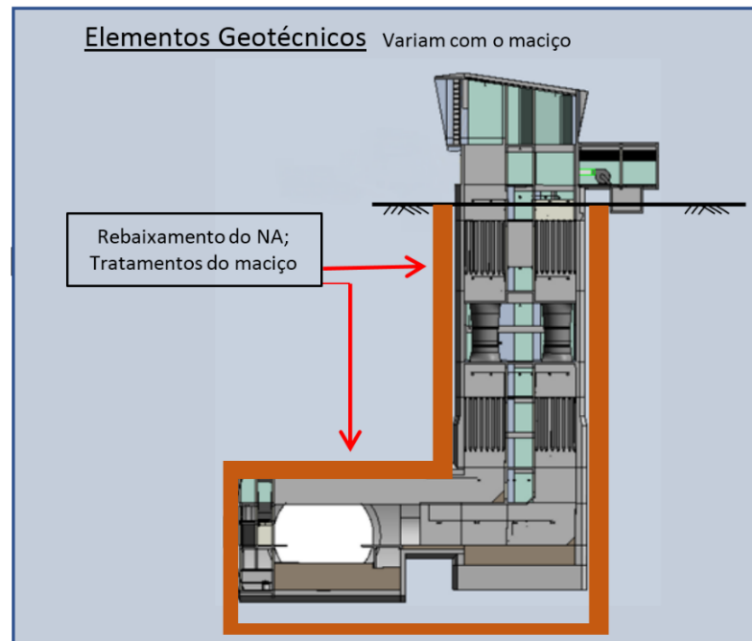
Elementos de condicionamento do maciço para escavação do poço e túneis
